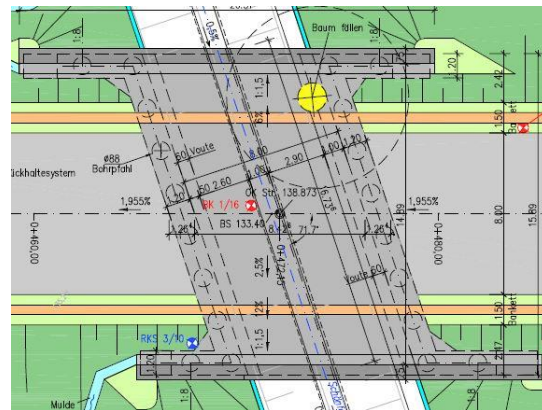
Grundriss des geplanten BW 01 mit Baumfällung (gelb) (IB KÜHNEL 2017)
